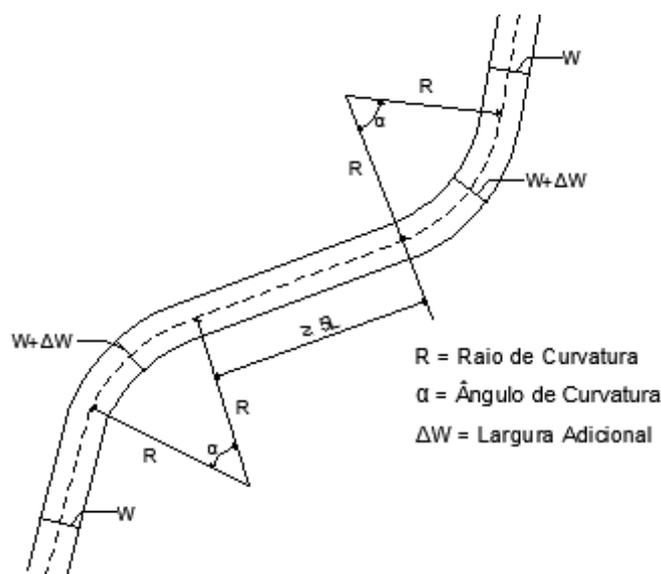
Configuração em planta do canal de aproximação – Fonte: Adaptado PIANC – PTC II-30, 1997
